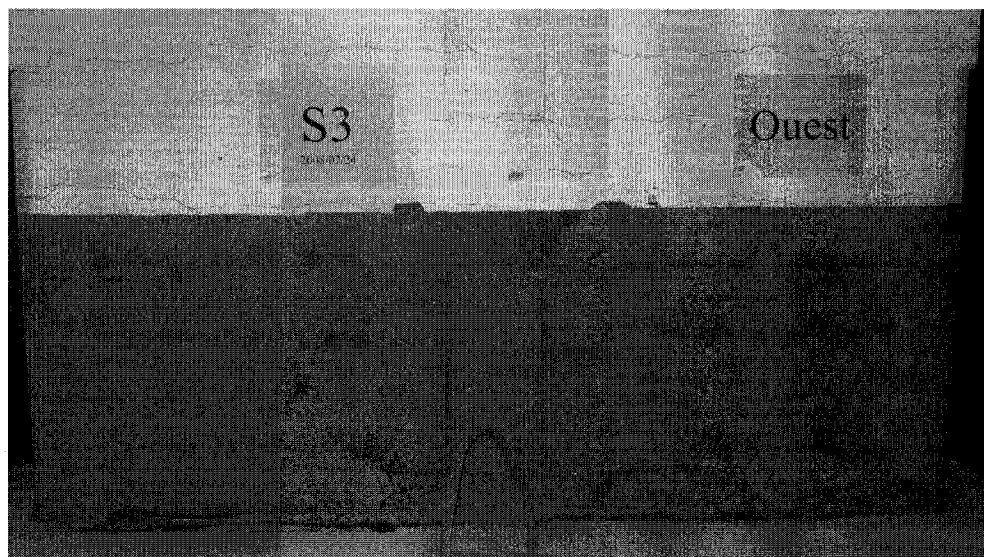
État du pilier 3 une fois le renforcement arraché
